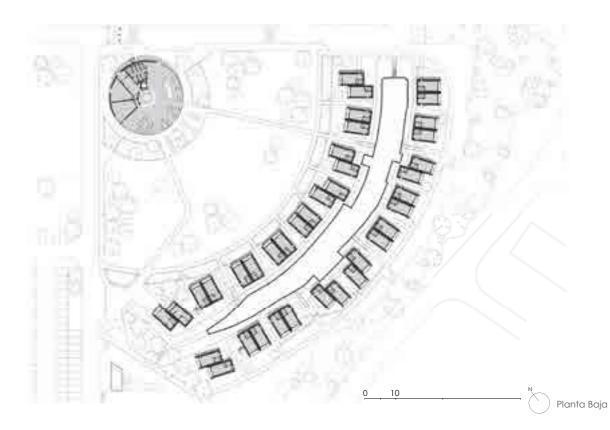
Esquematización de distribución de bloques y espacial en planta tipo obtenida de WilkinsonEyre por autoría propia.
